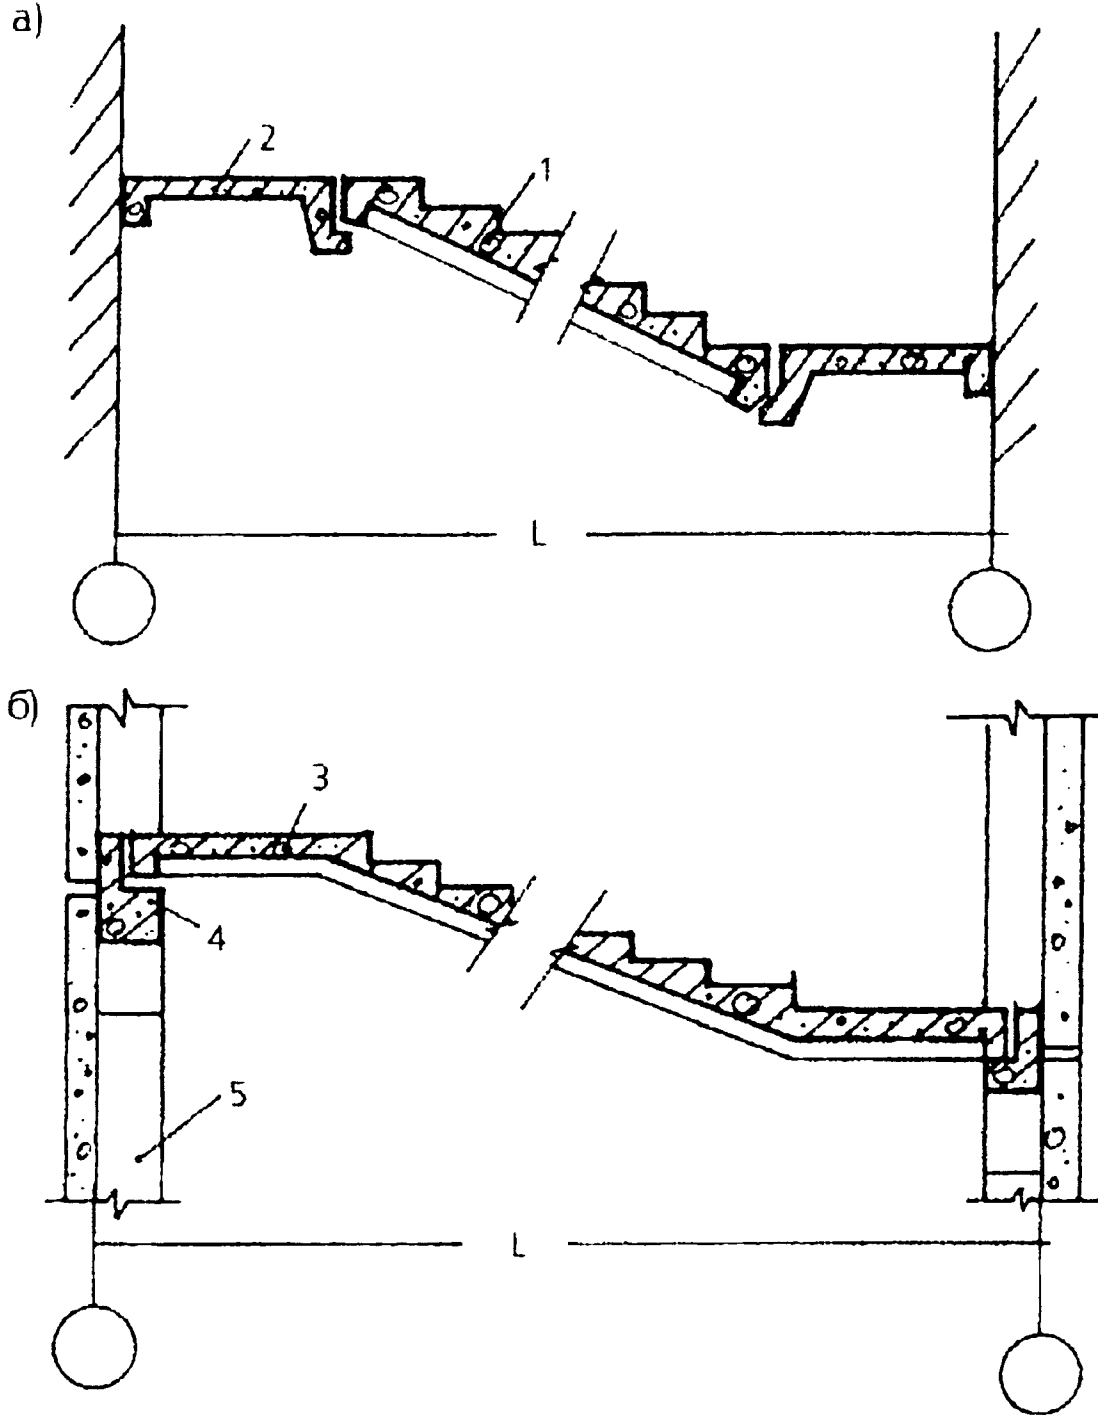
Конструкции железобетонных лестниц: а - 4-х элементная; б - 2-х элементная; 1 - лестничный марш; 2 - лестничная площадка; 3 - лестничный марш с полуплощадками; 4 - ригель; 5 - колонна
